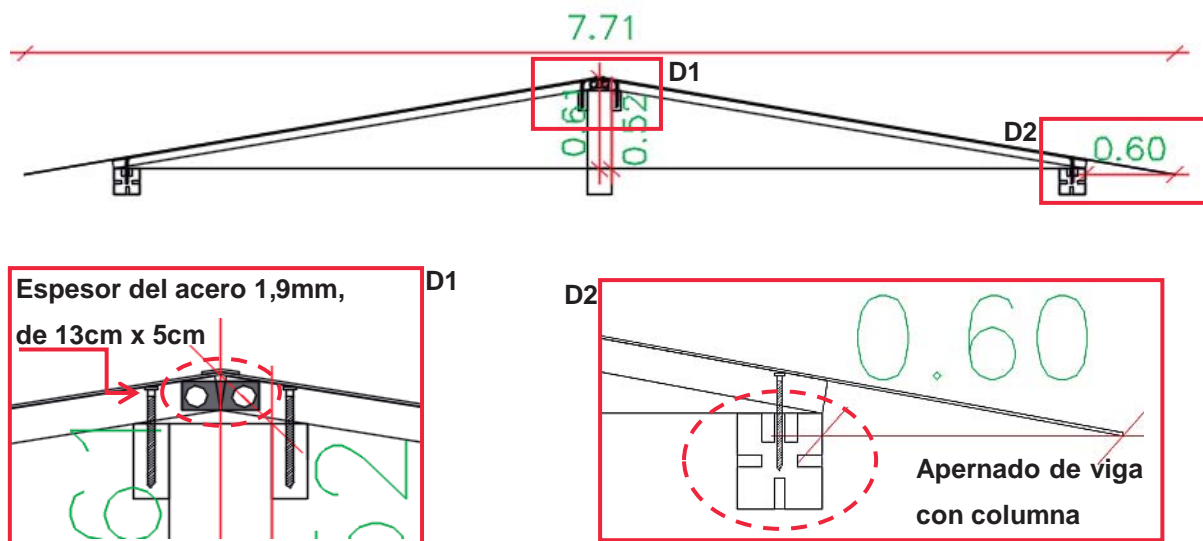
Anclaje de cubierta - AutoCAD, 2018
